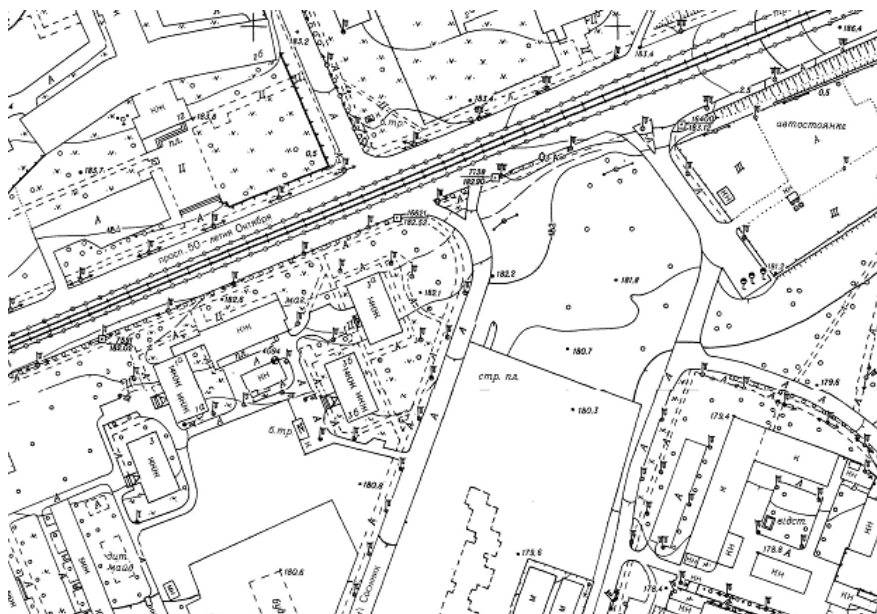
Опорний план 1К1 та 1 К2, просп. Леся Курбаса
